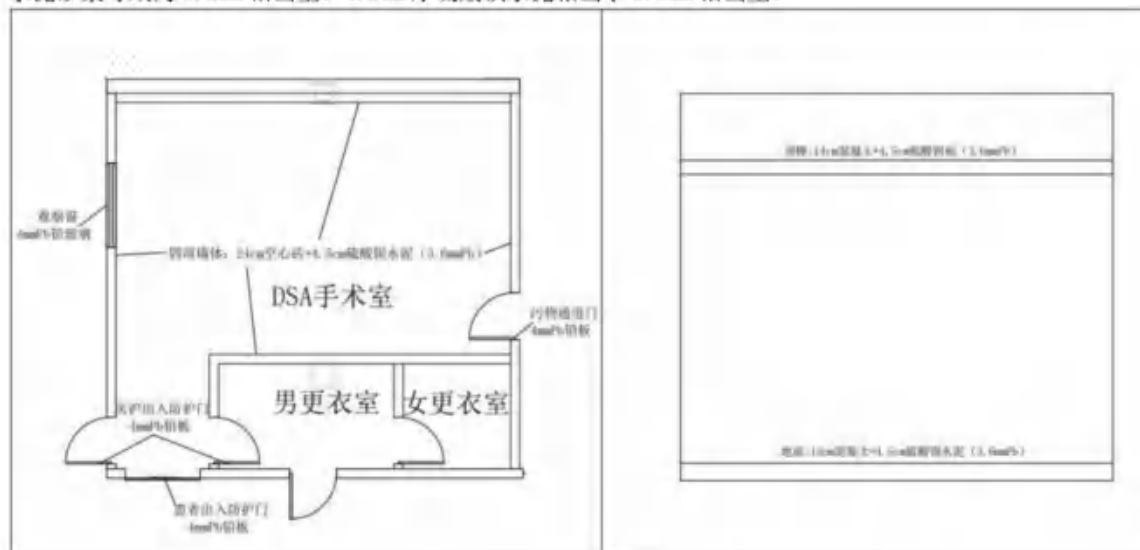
本项目 DSA 手术室四周墙体防护结构平面图及剖面图
